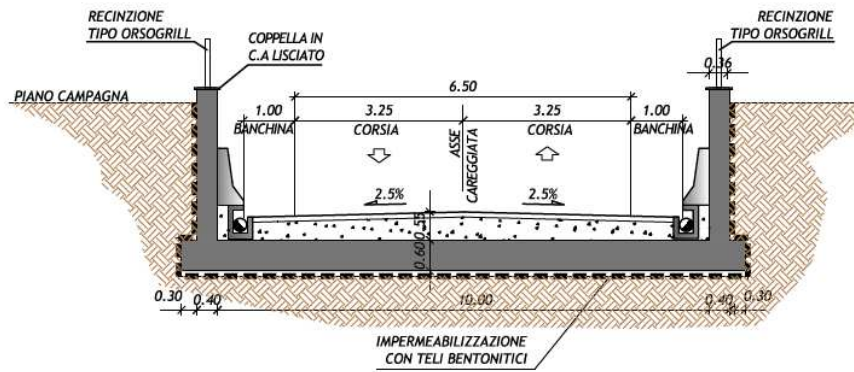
SEZIONE TIPO SCATOLARE APERTO A “U”
